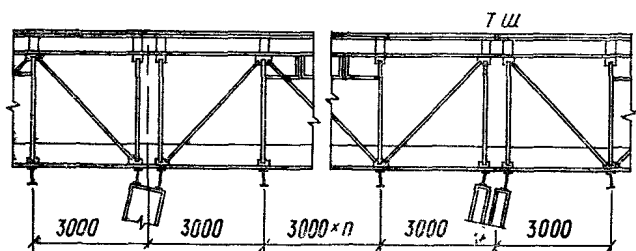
Фасад отопляемой галереи с облегченными конструкциями
